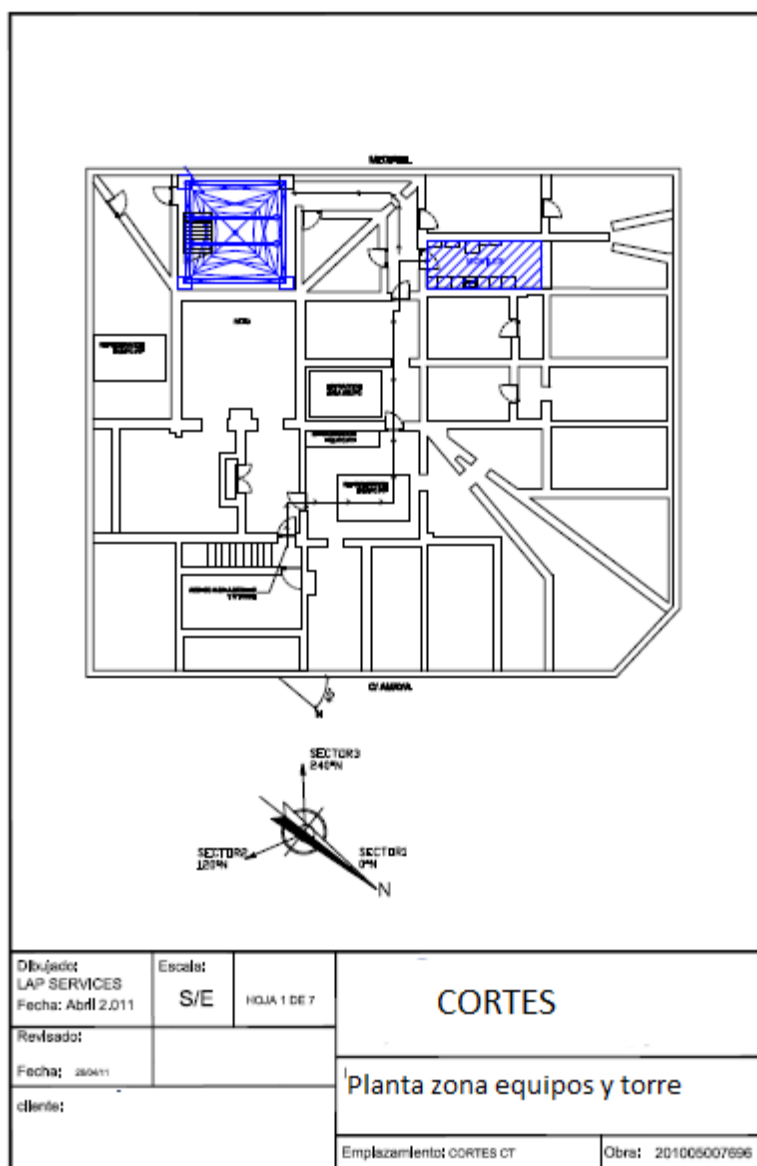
Plano planta zona de equipos y torre Cortes.
